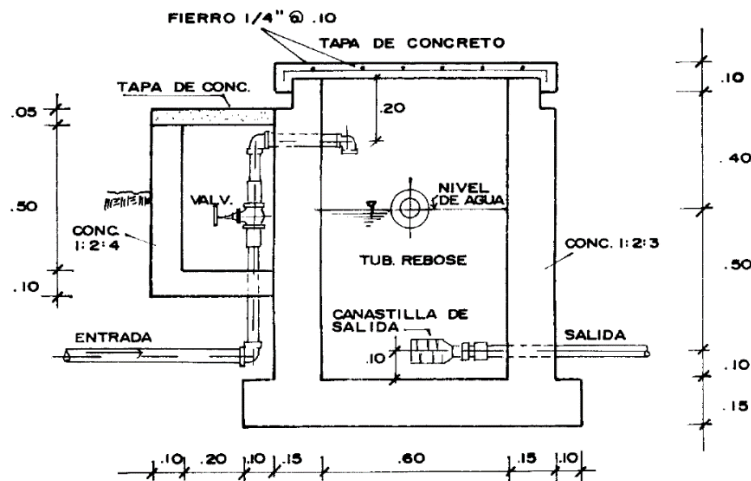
Cámara rompe presión- elev. Corte A-A'
